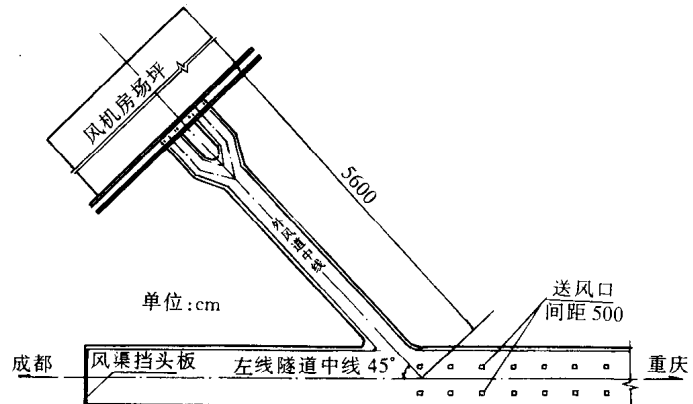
中梁山隧道（左线）西洞口通风道平面布置图
